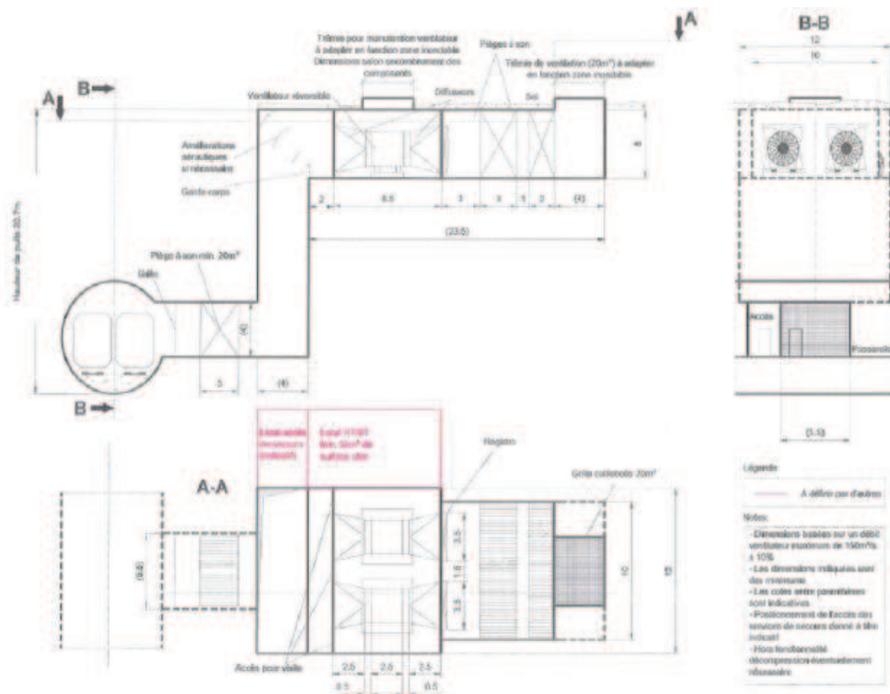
Plan type ouvrage annexe avec ventilateurs horizontaux (Source : STIF)
